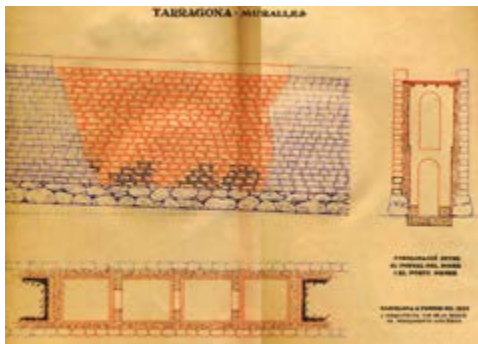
Alzado y secciones del proyecto de intervención de J. Martorell en la Bajada del Rosario, Año 1937 (ESTÉBAN 2007;; LACUESTA 2000).
